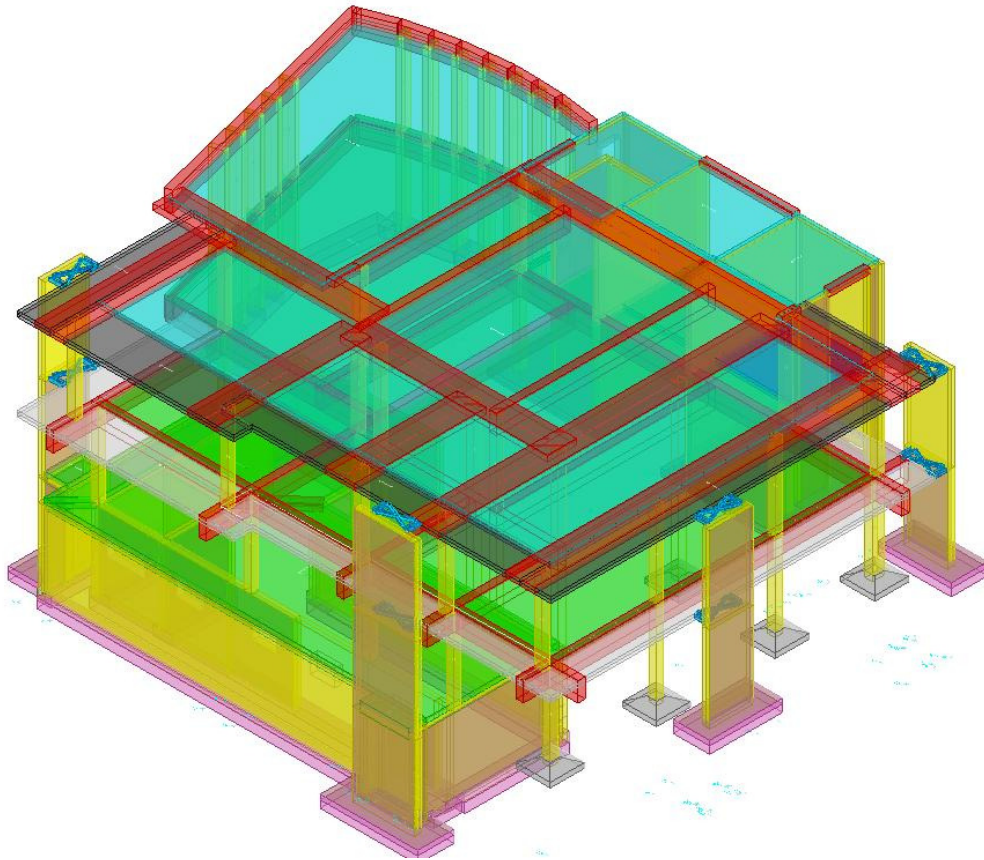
rappresentazione tridimensionale modello strutturale, vista 1
